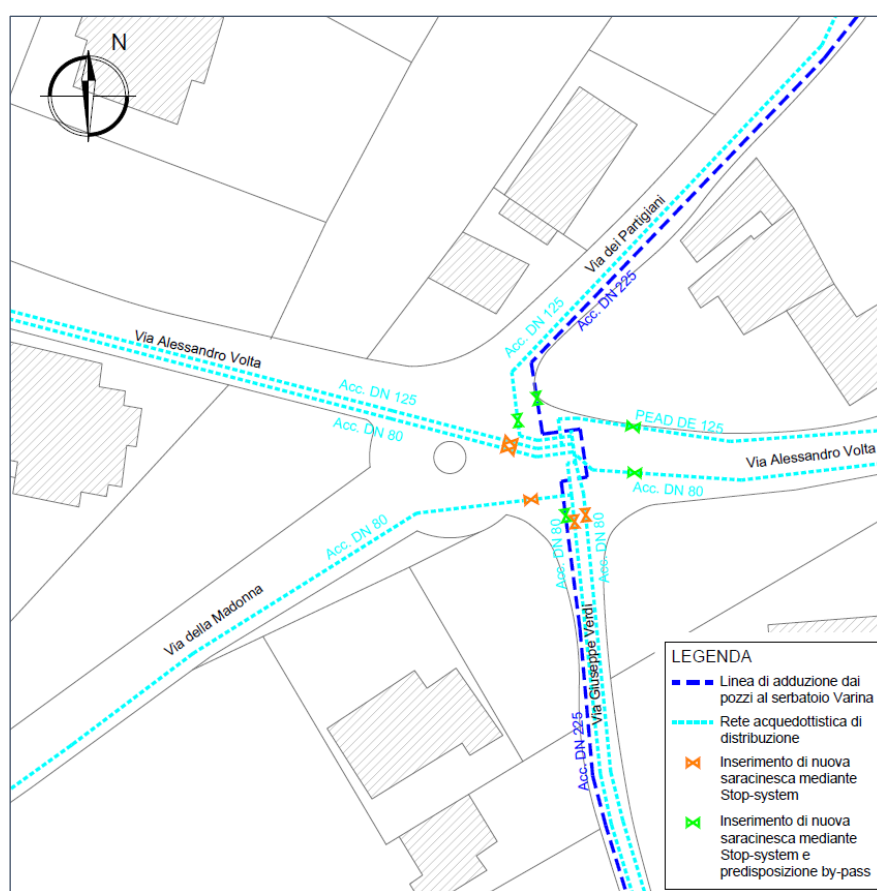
Rifacimento pozzetto incrocio Via Volta: planimetria area di intervento.
